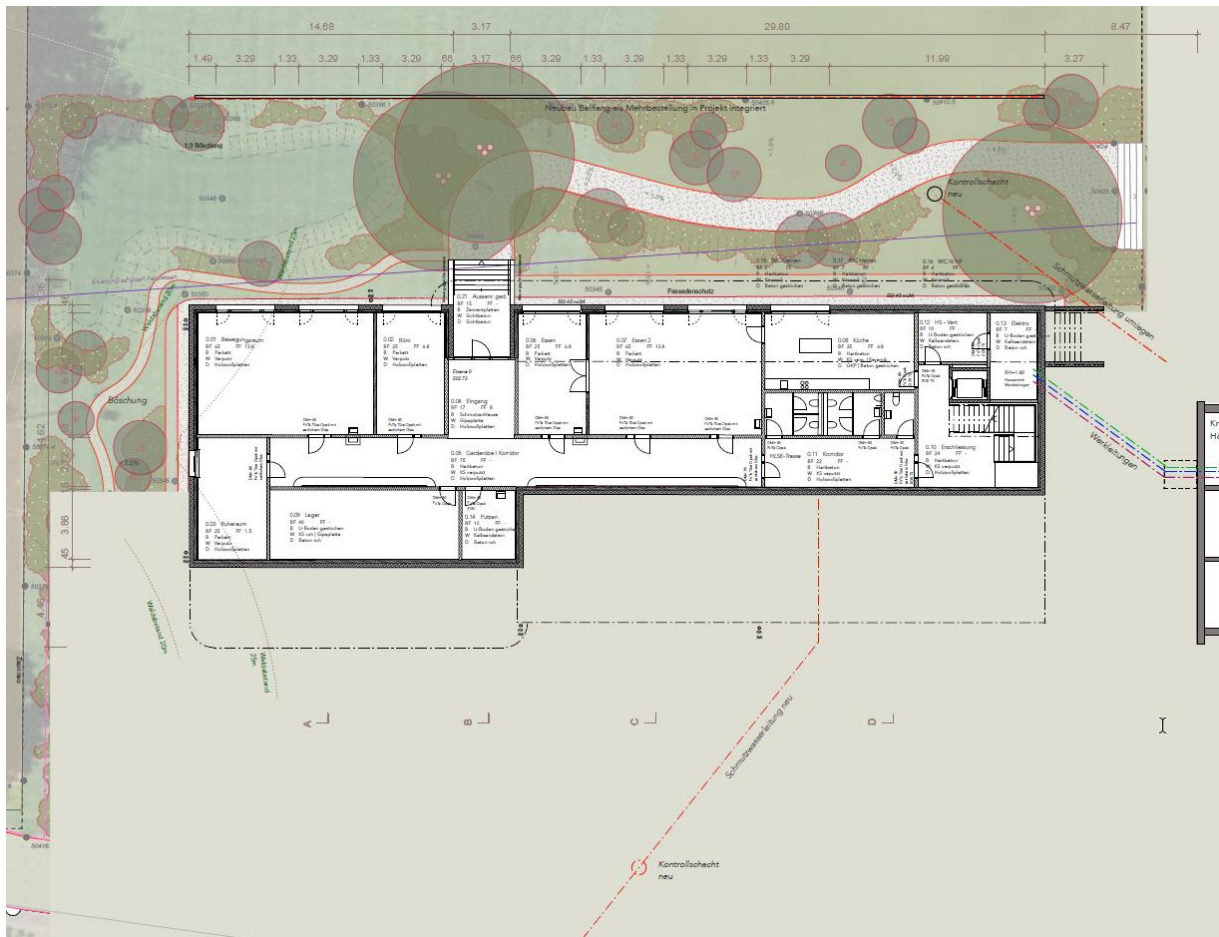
Grundriss Tagesschule, Ebene 0, Bauprojekt vom 08.08.2025
